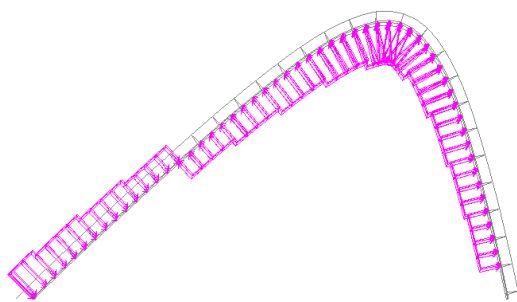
Загружение в ПК SCAD на фрагмент покрытия от ветровой нагрузки (Y+)
